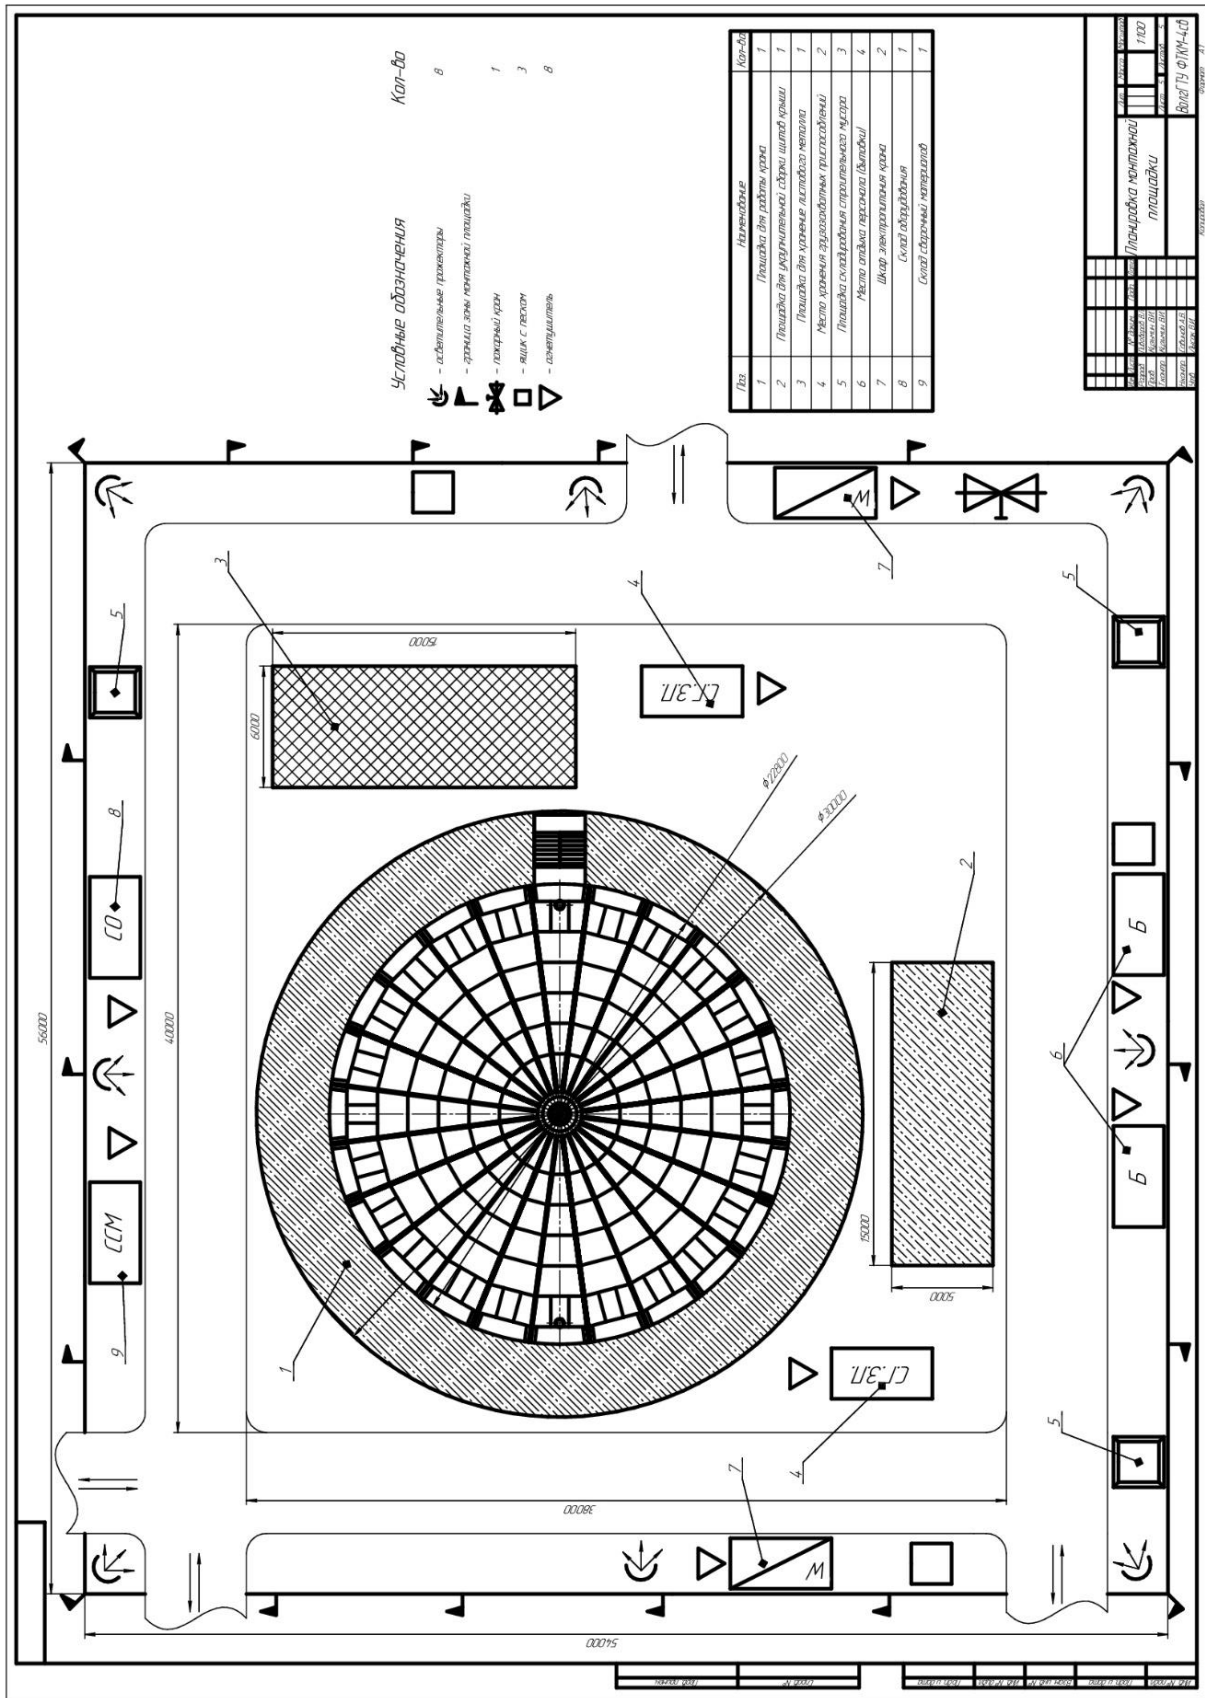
Пример планировки монтажной площадки сборки и сварки резервуара
